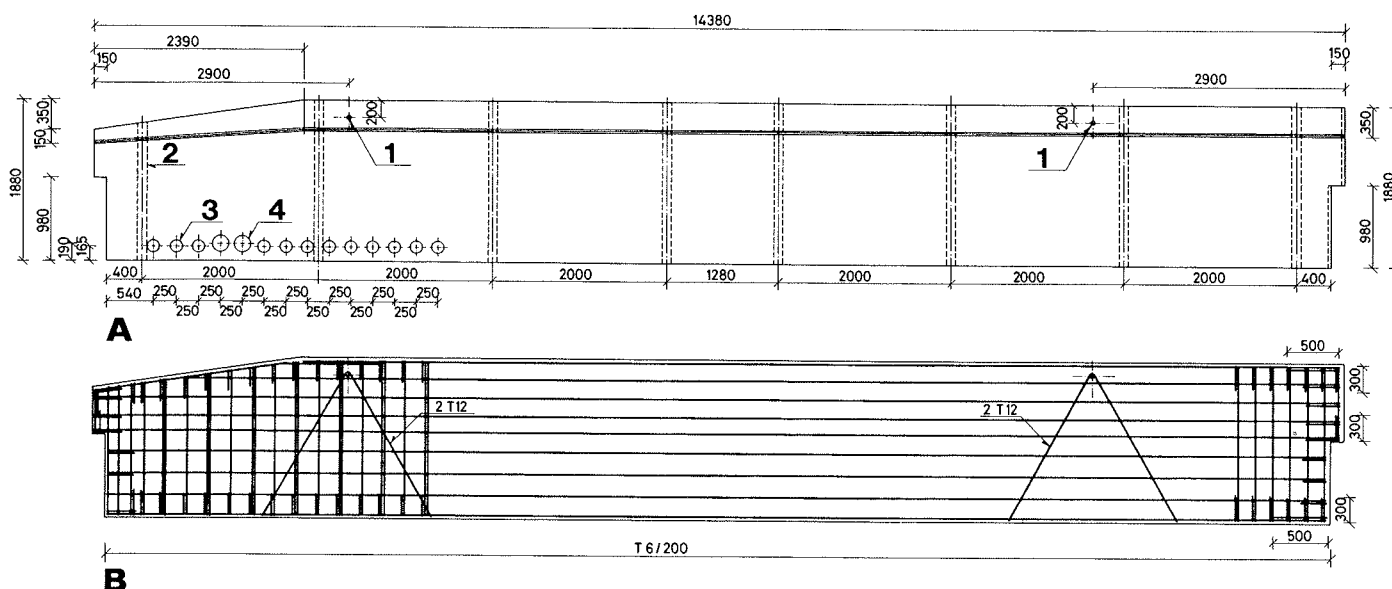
Betonelement i brandkam. Mål 1:100. (Se også fig. 6). Del A viser en opstalt af betonelementet med følgende detaljer: 1: Ø 40 plastrør, 2: Ø 60 korrugeret rør, 3: Ø 130 bøsningrør, 4: Ø 180 bøsningrør. Del B viser en opstalt af armeringen. Bemærk den skrå afskæring af betonelementets overside til venstre, hvilket skyldes et rent arkitektonisk ønske om ikke at kunne se brandkammen fra terræn.
